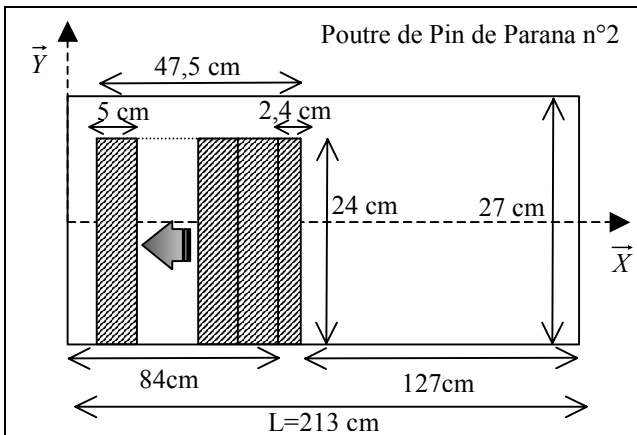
Plan de découpe dans la poutre de pin de Parana n°2.
